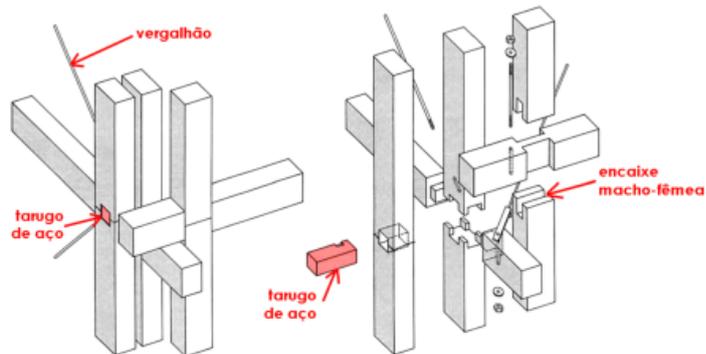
Nó estrutural. Encontro de vigas, pilaretes e vergalhões em quina. Fonte: autora.
